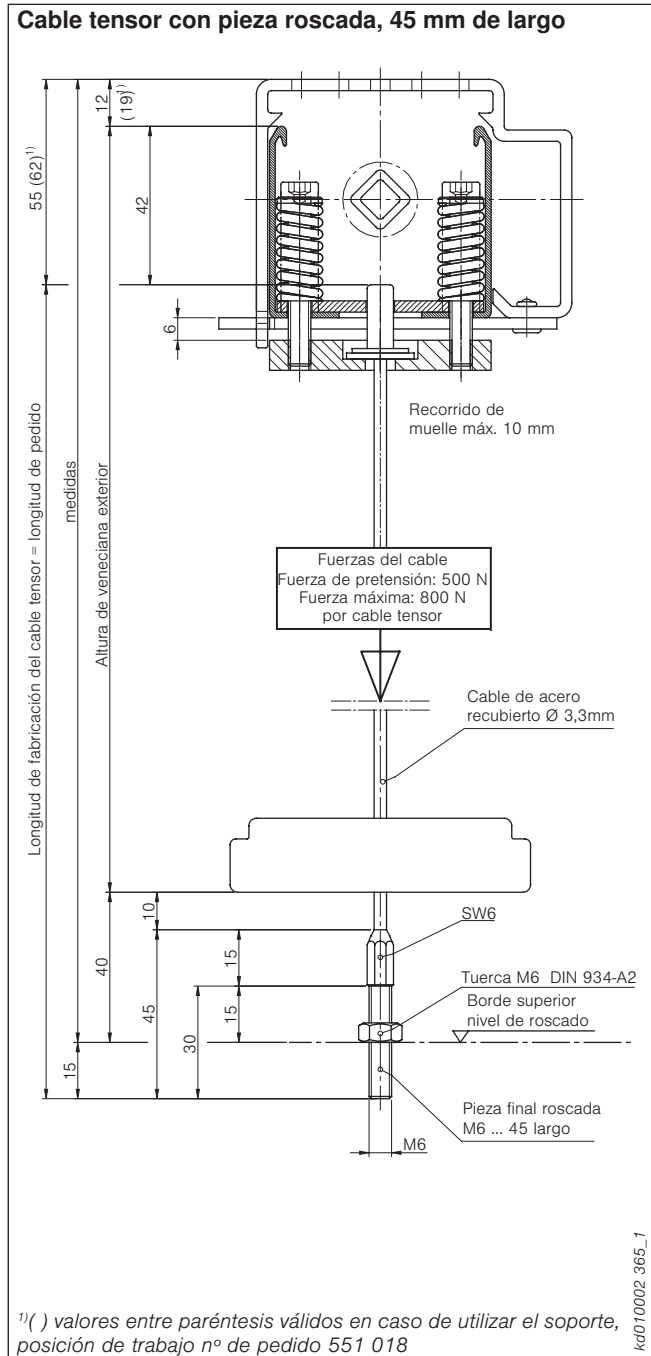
Cable tensor con pieza final roscada, 45 mm de largo
